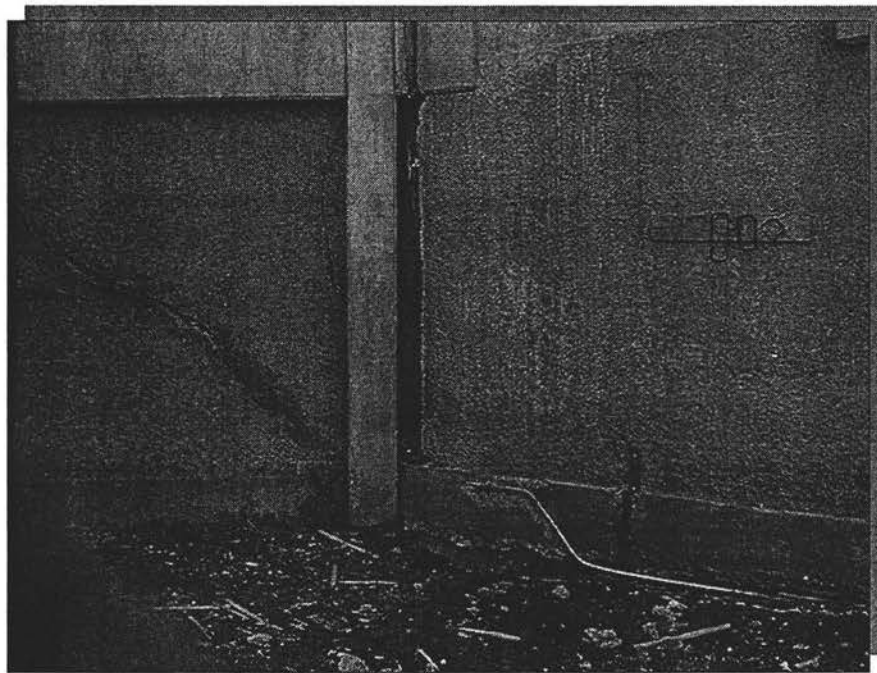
Daños en muros exteriores (grieta por tensión diagonal o cortante)
